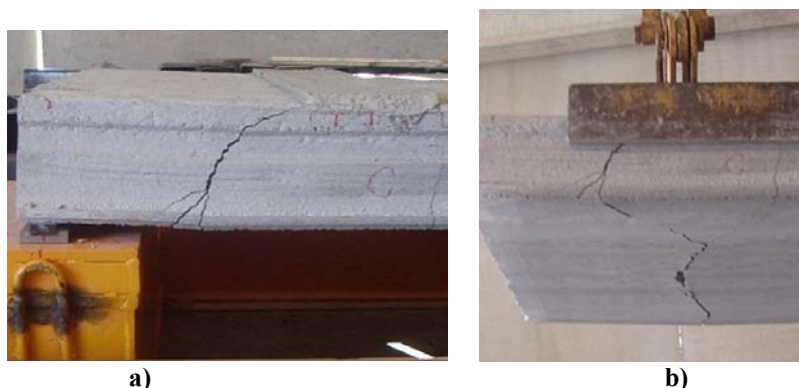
Ocorrência de fissuras na laje ensaiada ao cisalhamento: a) Abertura de fissura de cisalhamento com interação de flexão na lateral da laje; b) Abertura de fissuras na parte inferior da laje.
